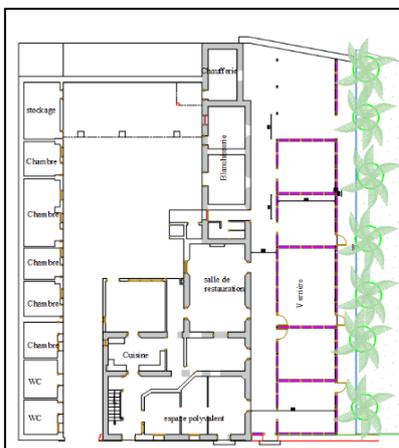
schéma en plan de l'ensoleillement , Source: auteur
